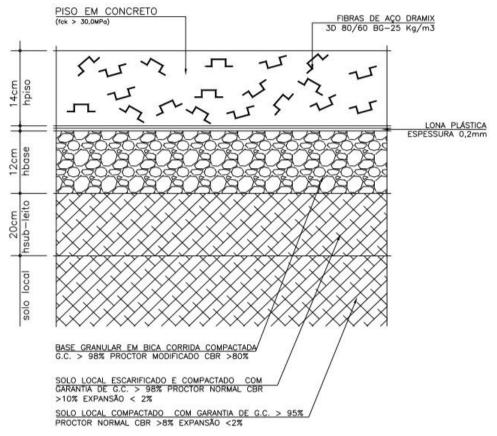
Detalhe de pavimento de concreto com fibras de aço.
